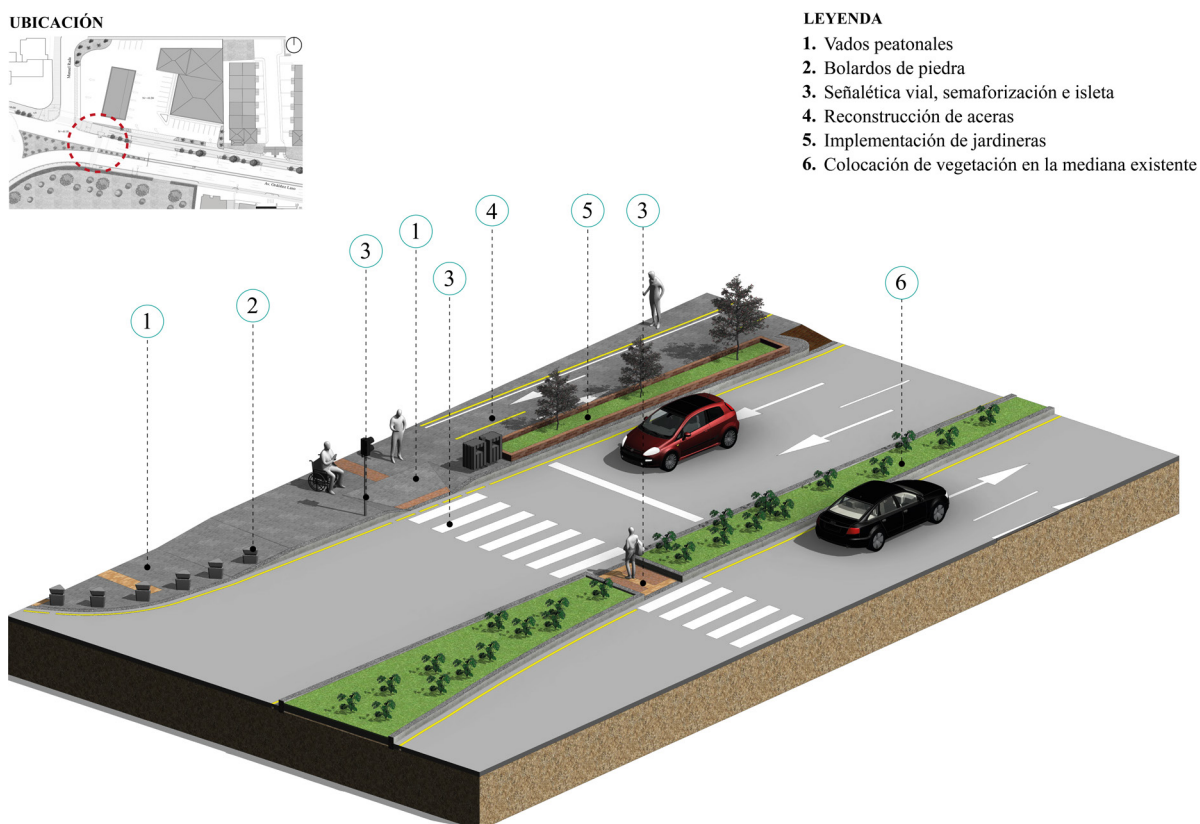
Mejoramiento de infraestructura vial y accesibilidad. Fuente y elaboración: Autoras.
